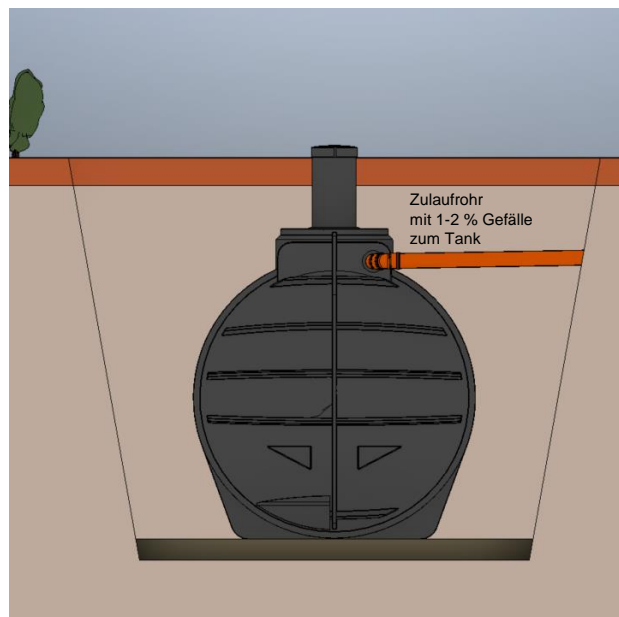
Anschluss der Abwassergrundleitung (Zulaufrohr)
